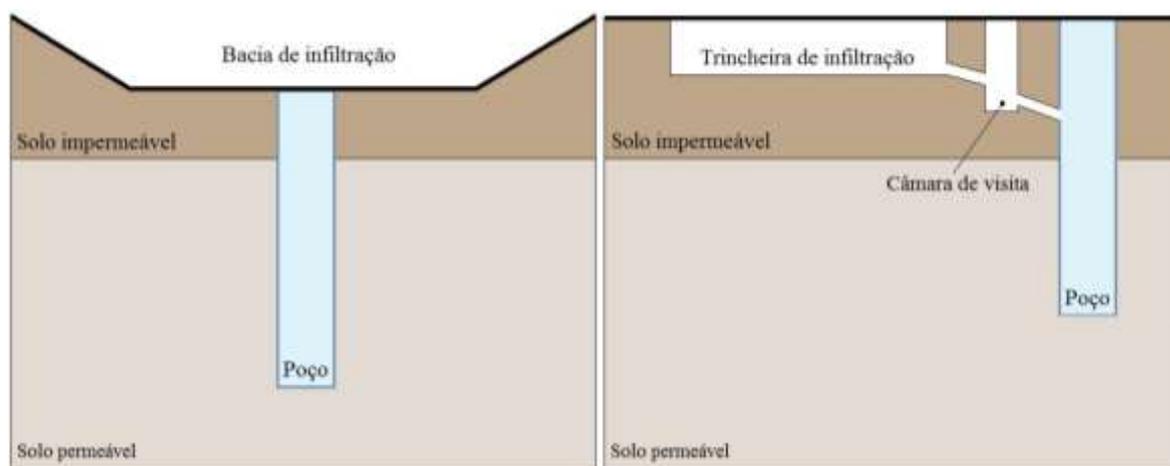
Poço de infiltração em associação com uma bacia de infiltração e uma trincheira de infiltração
